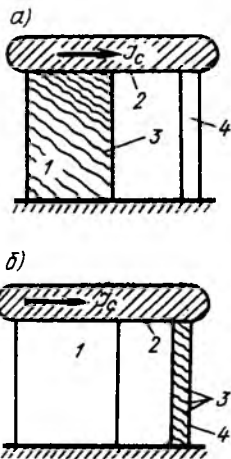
Расчетная схема типового этажа каркасного здания а — ожидаемая схема разрушения; б — то же фактическая; 1 — диафрагма жесткости; 2 — диск перекрытия; 3 — трещины; 4 — колонны
